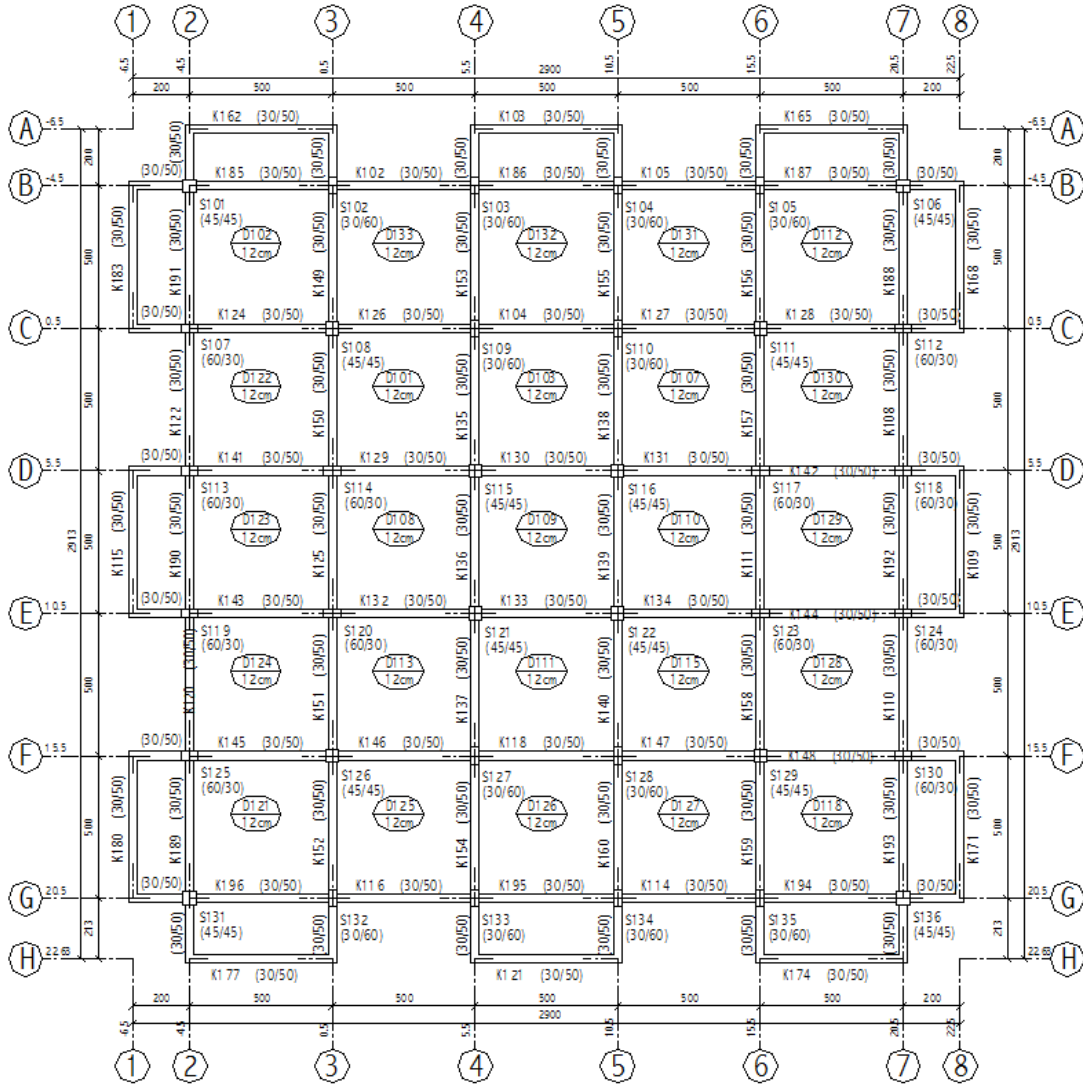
Bina B 5 katlı basık kirişli plan bilgisi
